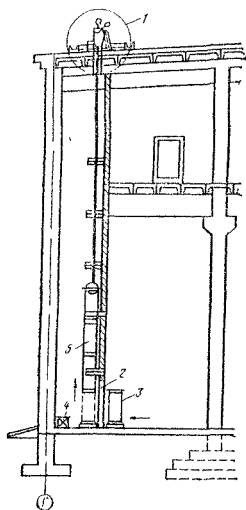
Схема монтажа вертикальных воздухопроводов внутри здания рычажной лебедкой, установленной на кровле
